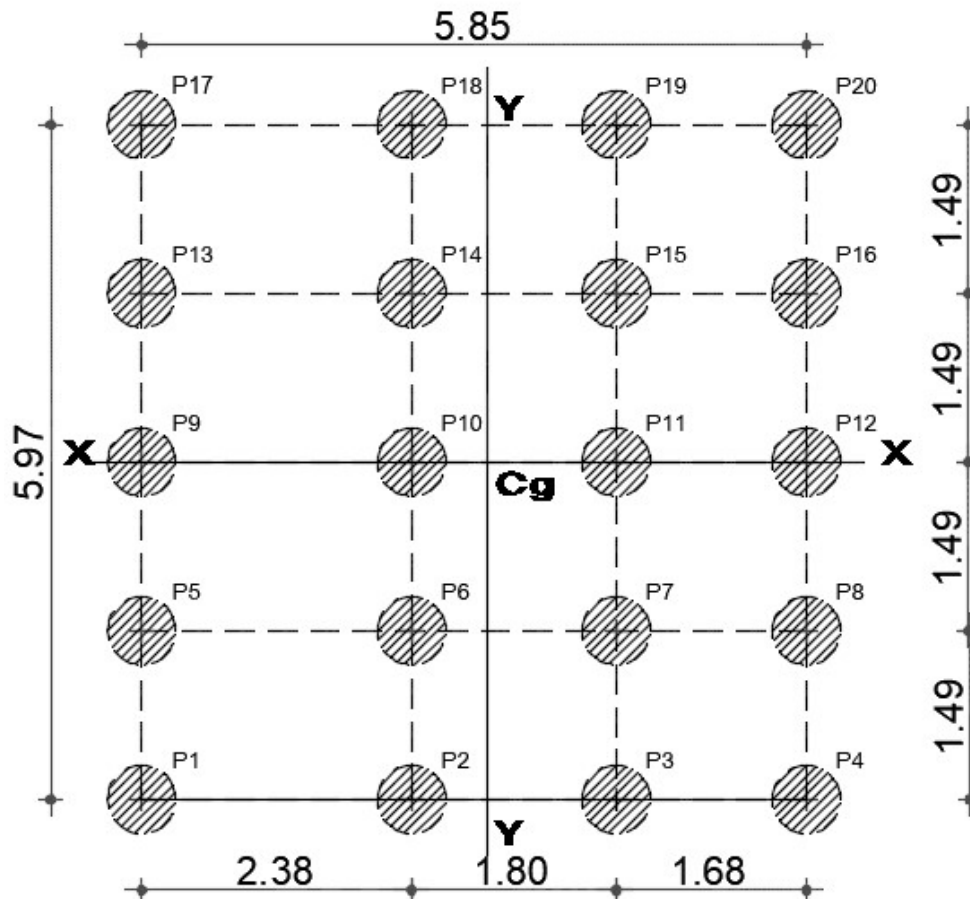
Croquis del diseño propuesto de distribución de pilotes.
